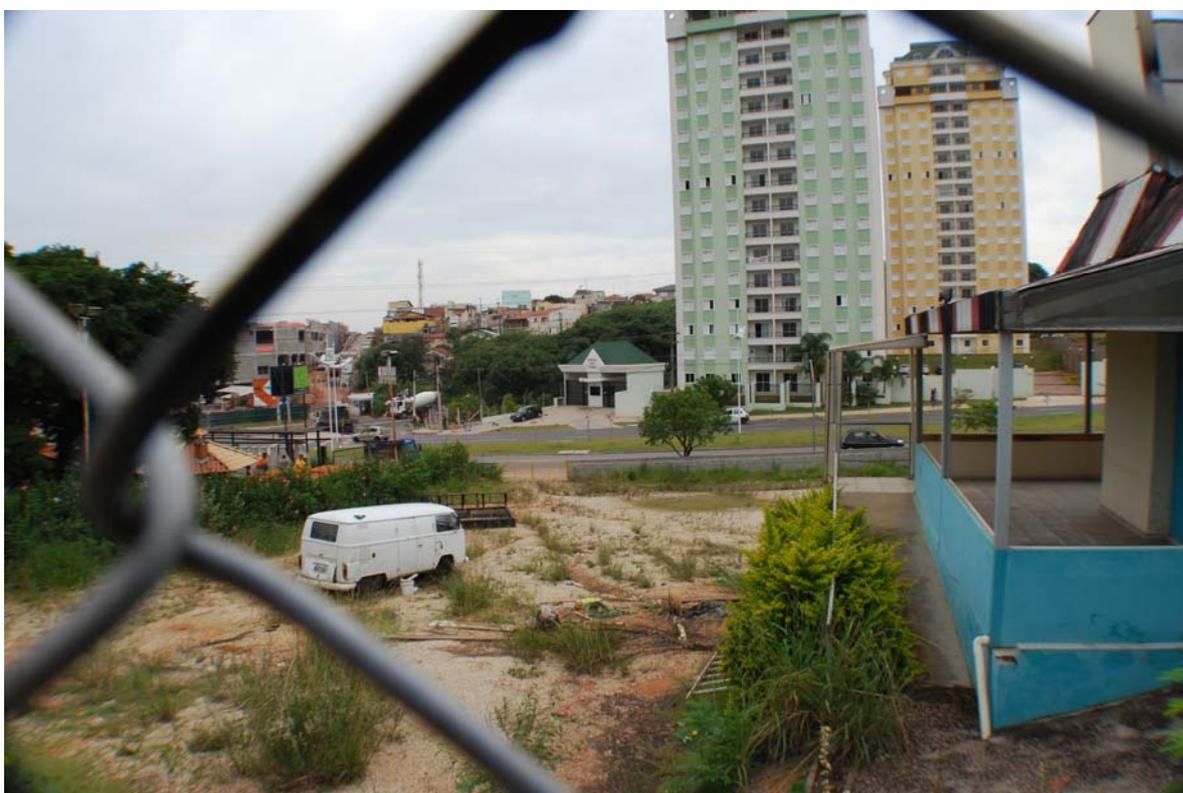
Terreno do futuro empreendimento. Vista da Rua Dr. Paulo Moutran em direção à Av. Nove de Julho.
